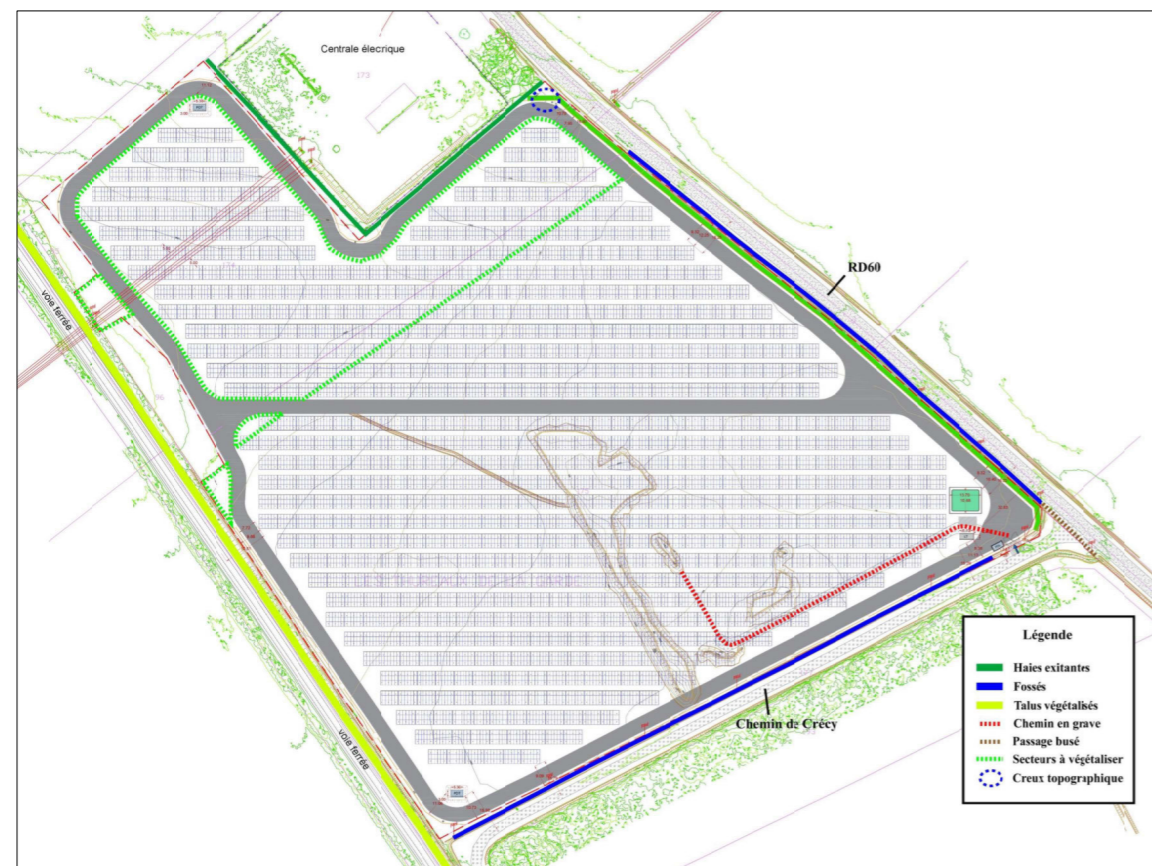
Plan des propositions pour la gestion des eaux pluviales
